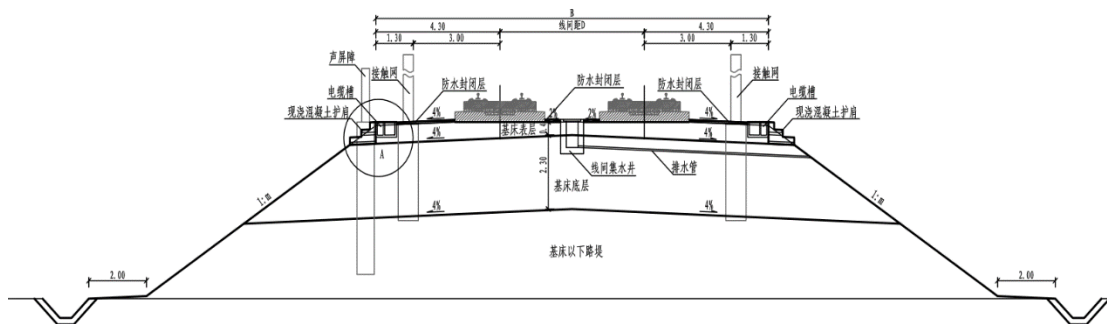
正线区间双线无砟轨道直线地段路堤标准横断面图
